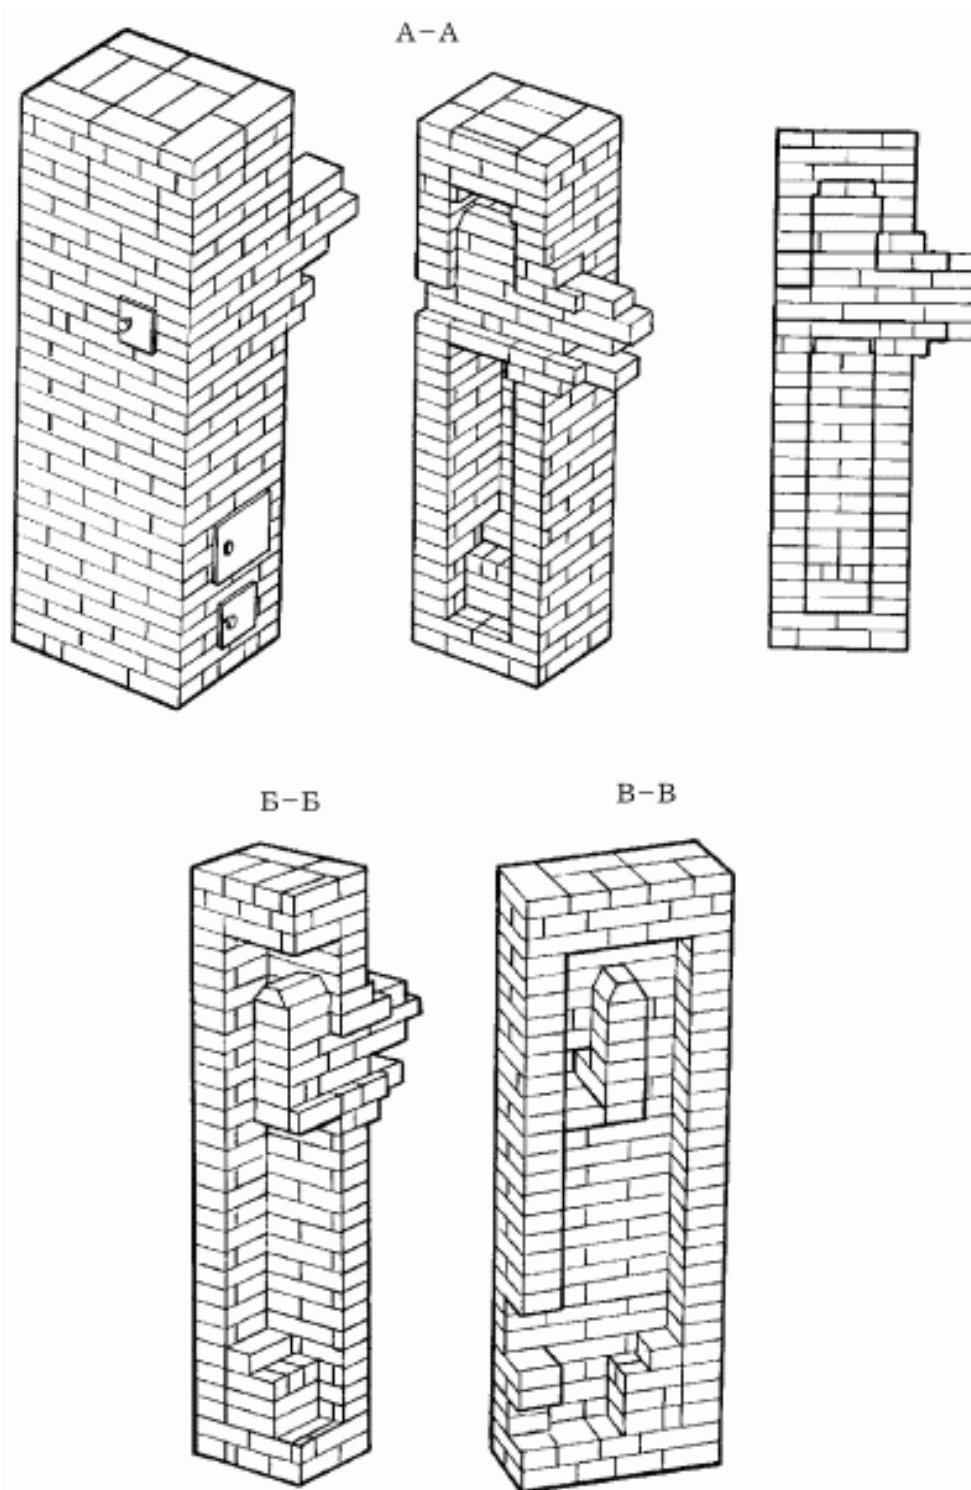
Прямоугольная бесканальная отопительная печь. Последовательность кладки.
